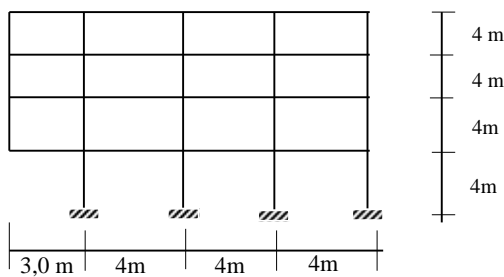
Tampak samping struktur Bangunan Dengan panjang tonjolan 0%
